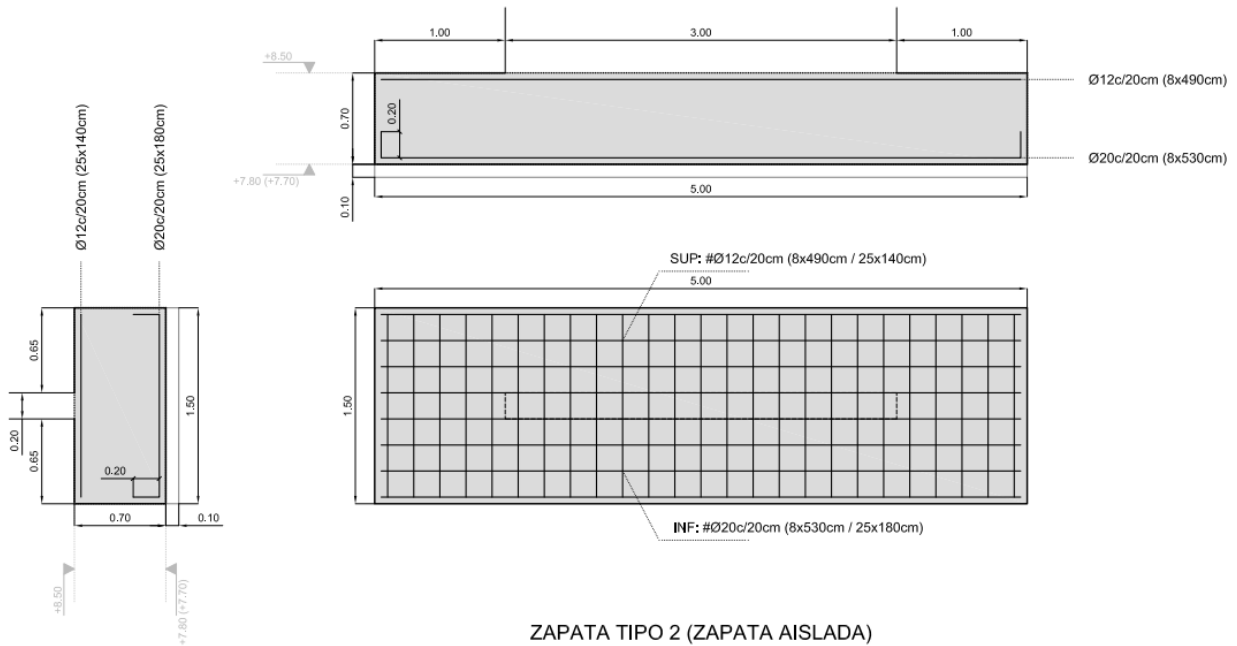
Armado zapata tipo 02. Fuente: David Gallardo.
